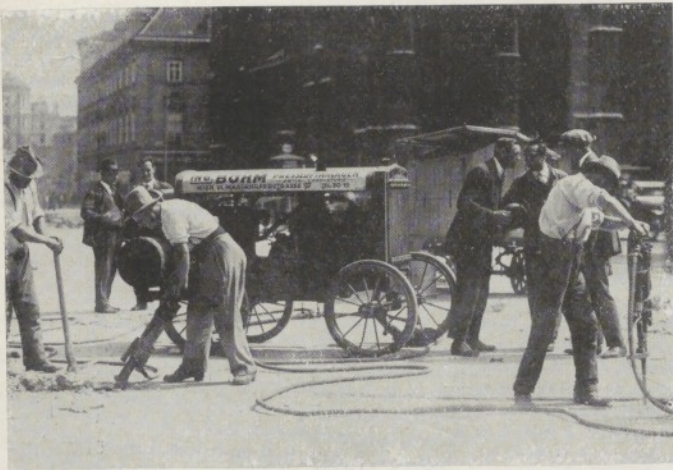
Kompressoranlage beim Aufbruch einer Makadamstraße.
